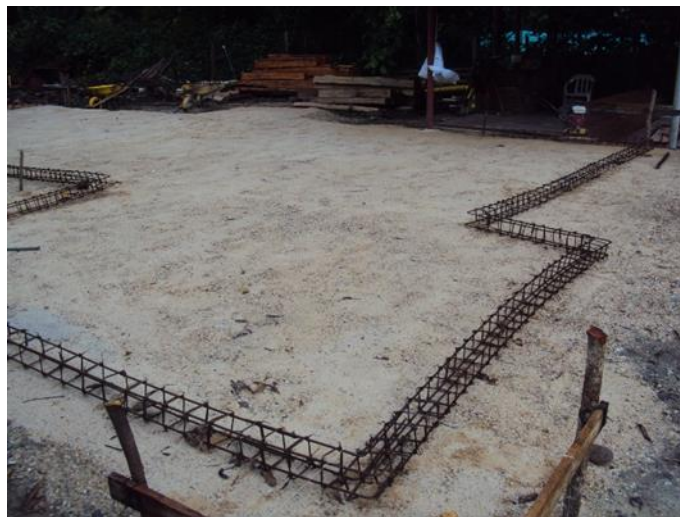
Canasta perimetral cimentación, adaptado obra civil llanos orientales.
